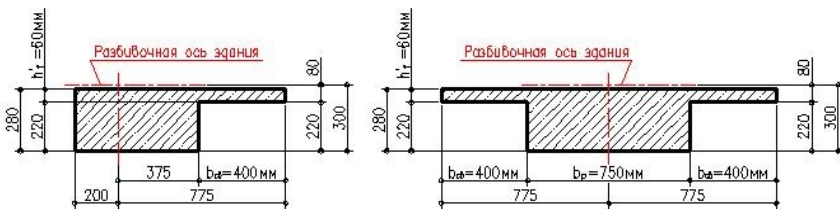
Монолитные ригели перекрытия (крайние и рядовые)
